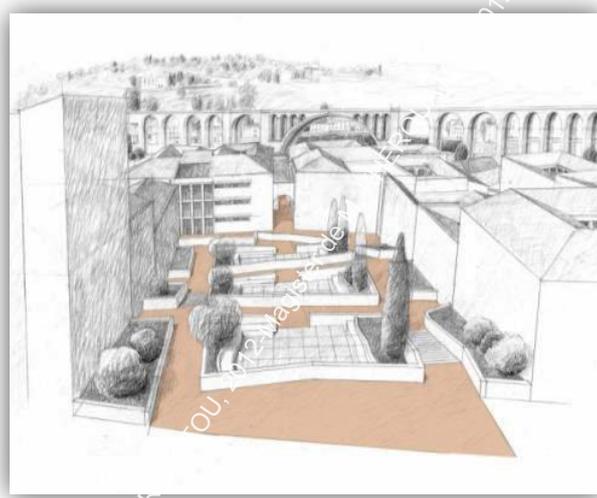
Vue sur l'aménagement de la place Hallama. Source Master Plan 2005
